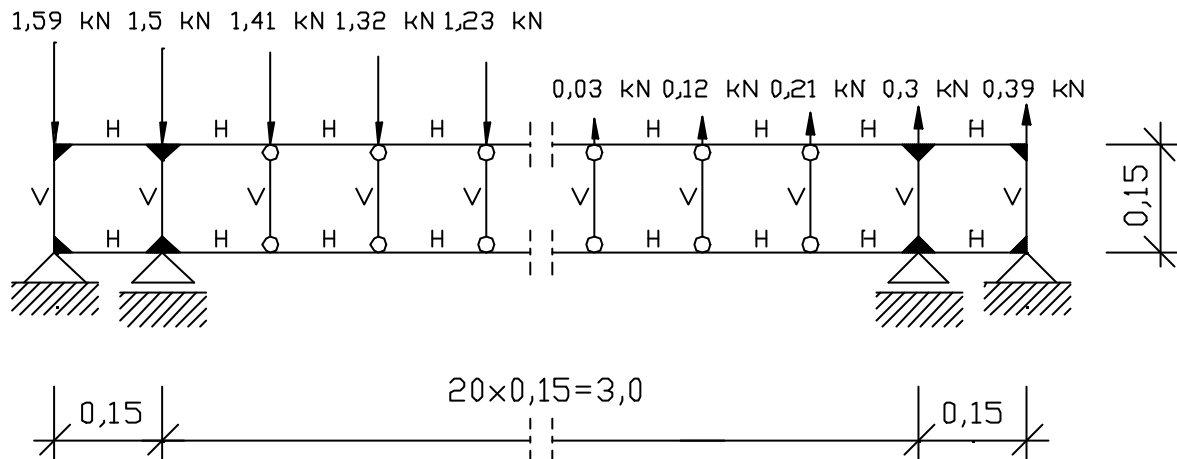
Ersatzmodell mit Stabnummerierung für Brettlagenholz mit orthogonaler Struktur
